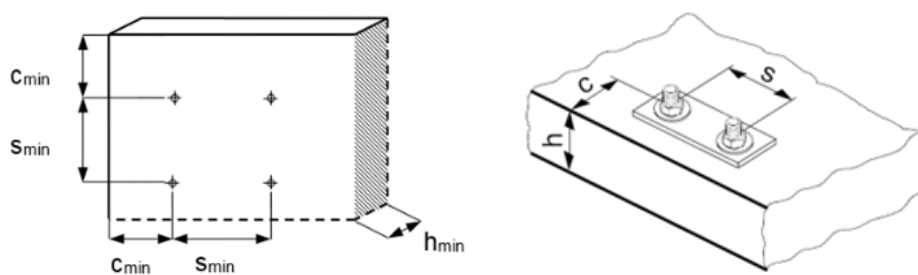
Randabstand, Abstand und Betonplattenstärke
